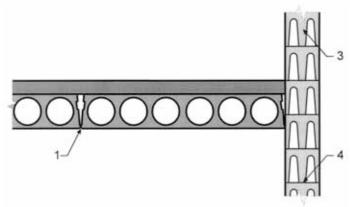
Dalles de 20 cm d'épaisseur avec une chape de 8 cm parallèles à une façade en blocs creux en béton de 20 cm
